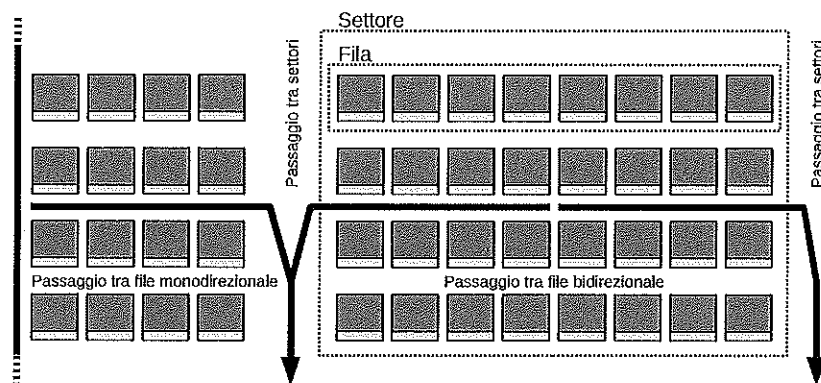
Disposizione dei posti a sedere in settori e file, in pianta
